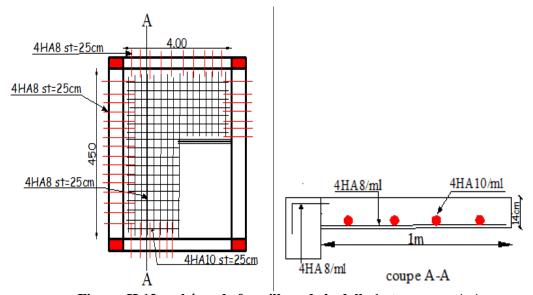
schéma de ferraillage de la dalle 1 et sa coupe A-A.
